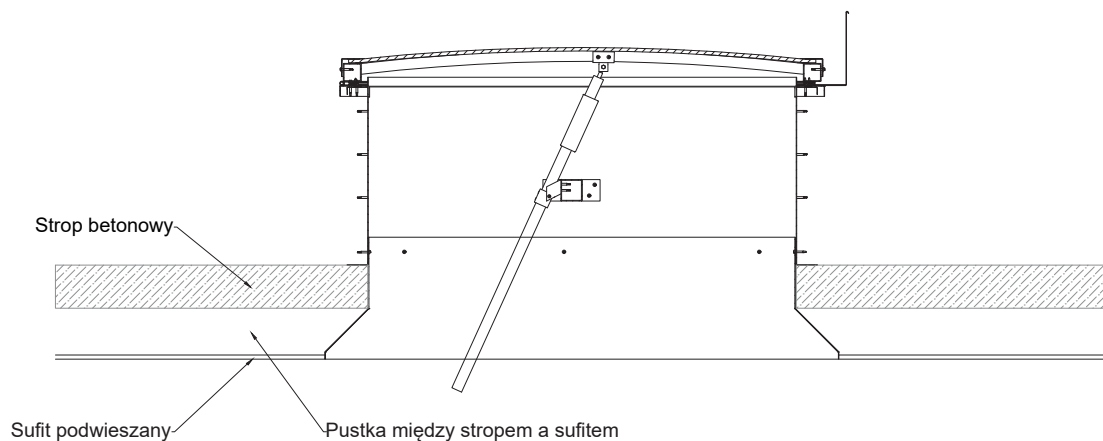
Przekrój klapy z termoizolacją dla montażu do stropu betonowego.
